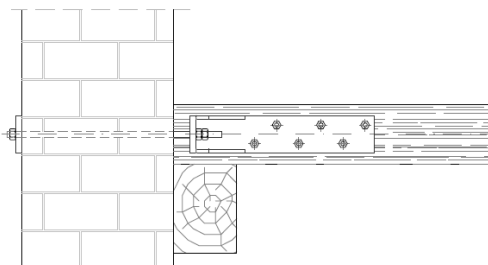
Intervenção de reforço entre pavimentos de madeira e a parede de alvenaria. [26]
